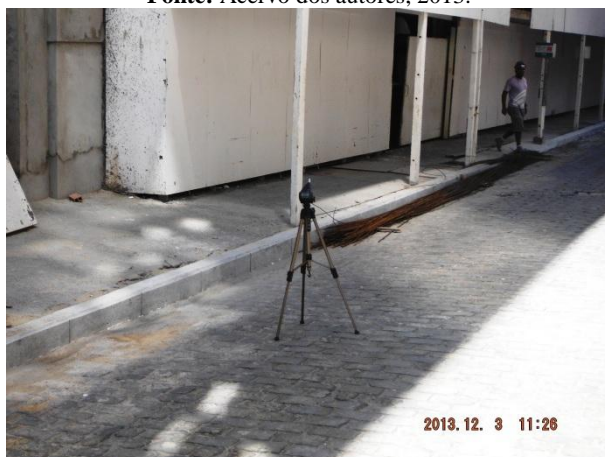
Decibelímetro instalado junto a empreendimento para medição sonora diurna na fase 3 – acabamento em local de corte de cerâmica com a maquieta em funcionamento.
